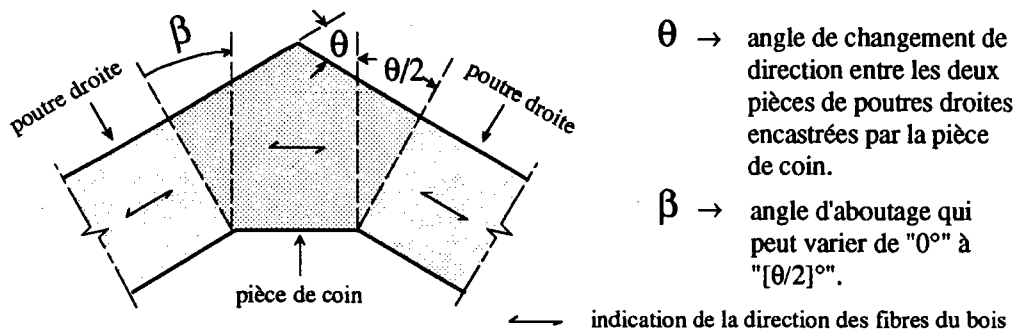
Indication de l'angle d'aboutage " β " pour un assemblage de coin.
